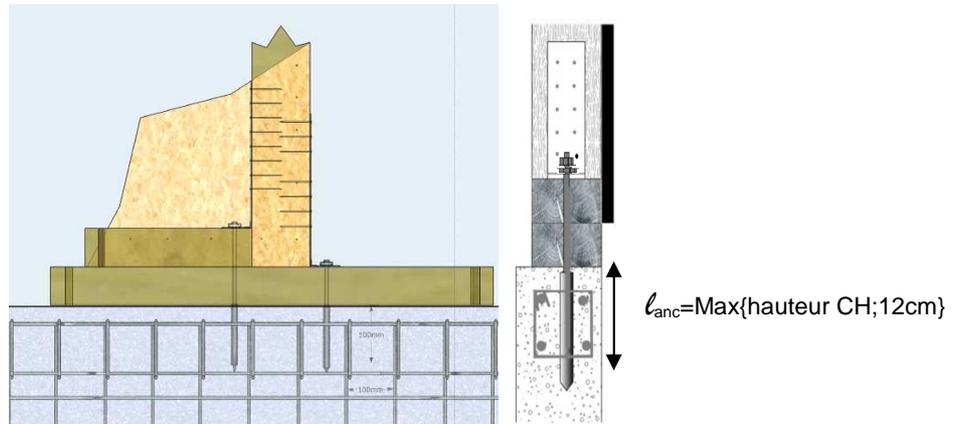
Schémas de principe d'ancrage d'un panneau VT par chevilles métalliques dans la fondation
